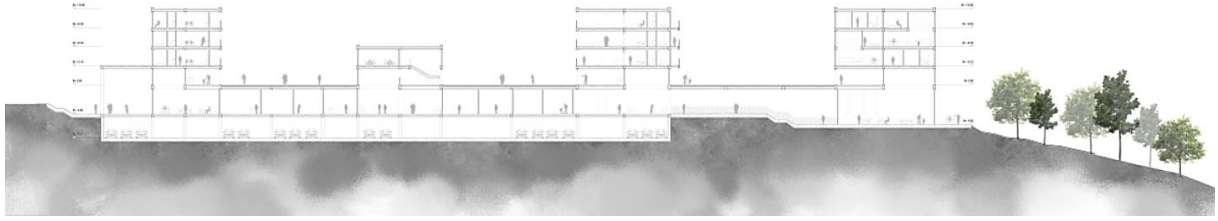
Corte longitudinal a través del proyecto. Elaboración propia.
